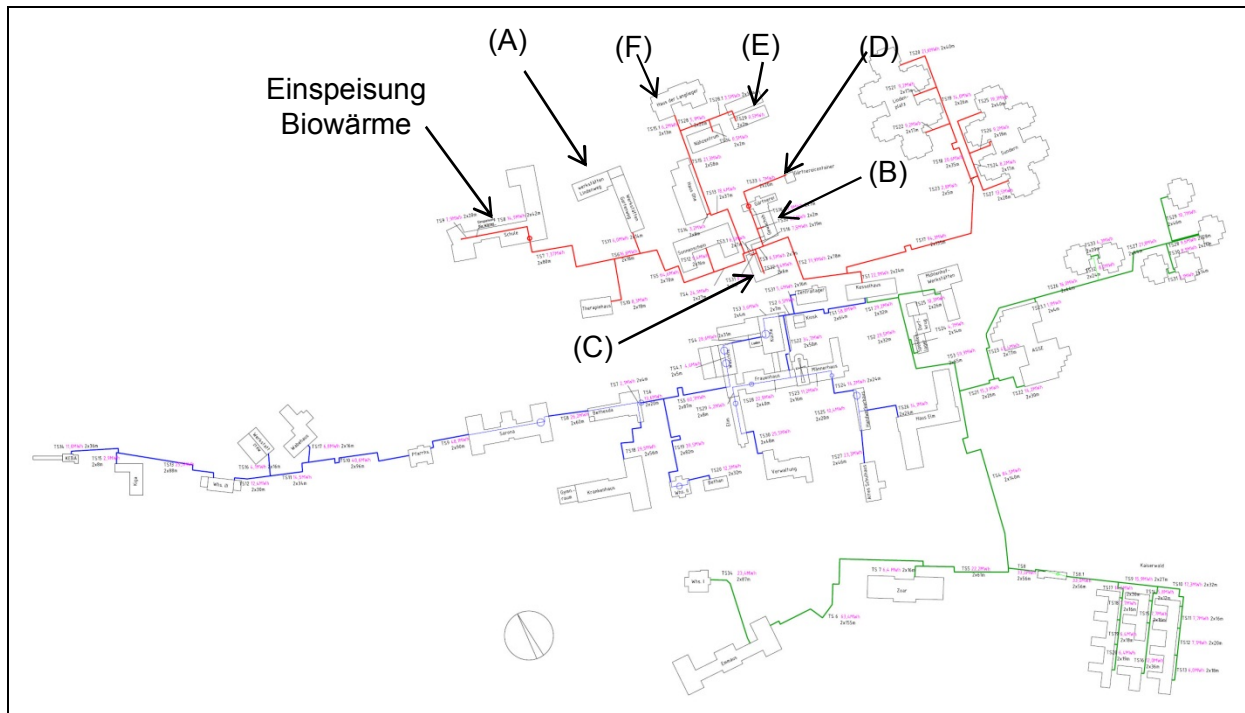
Lageplan mit Übersicht Rücklaufanhebungen im Nahwärmenetz
